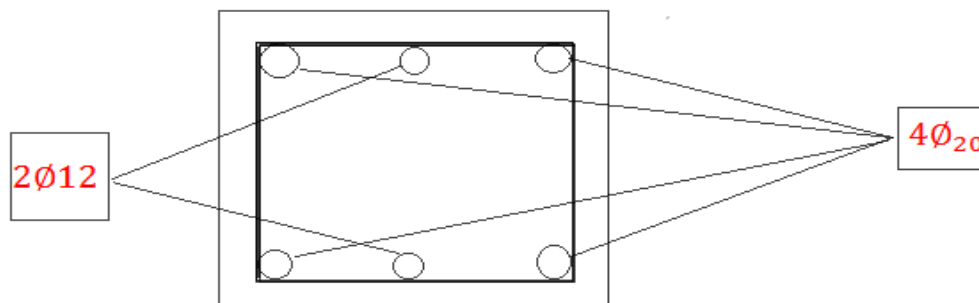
Ferrailage de la section du poteau en compression selon le code BS
